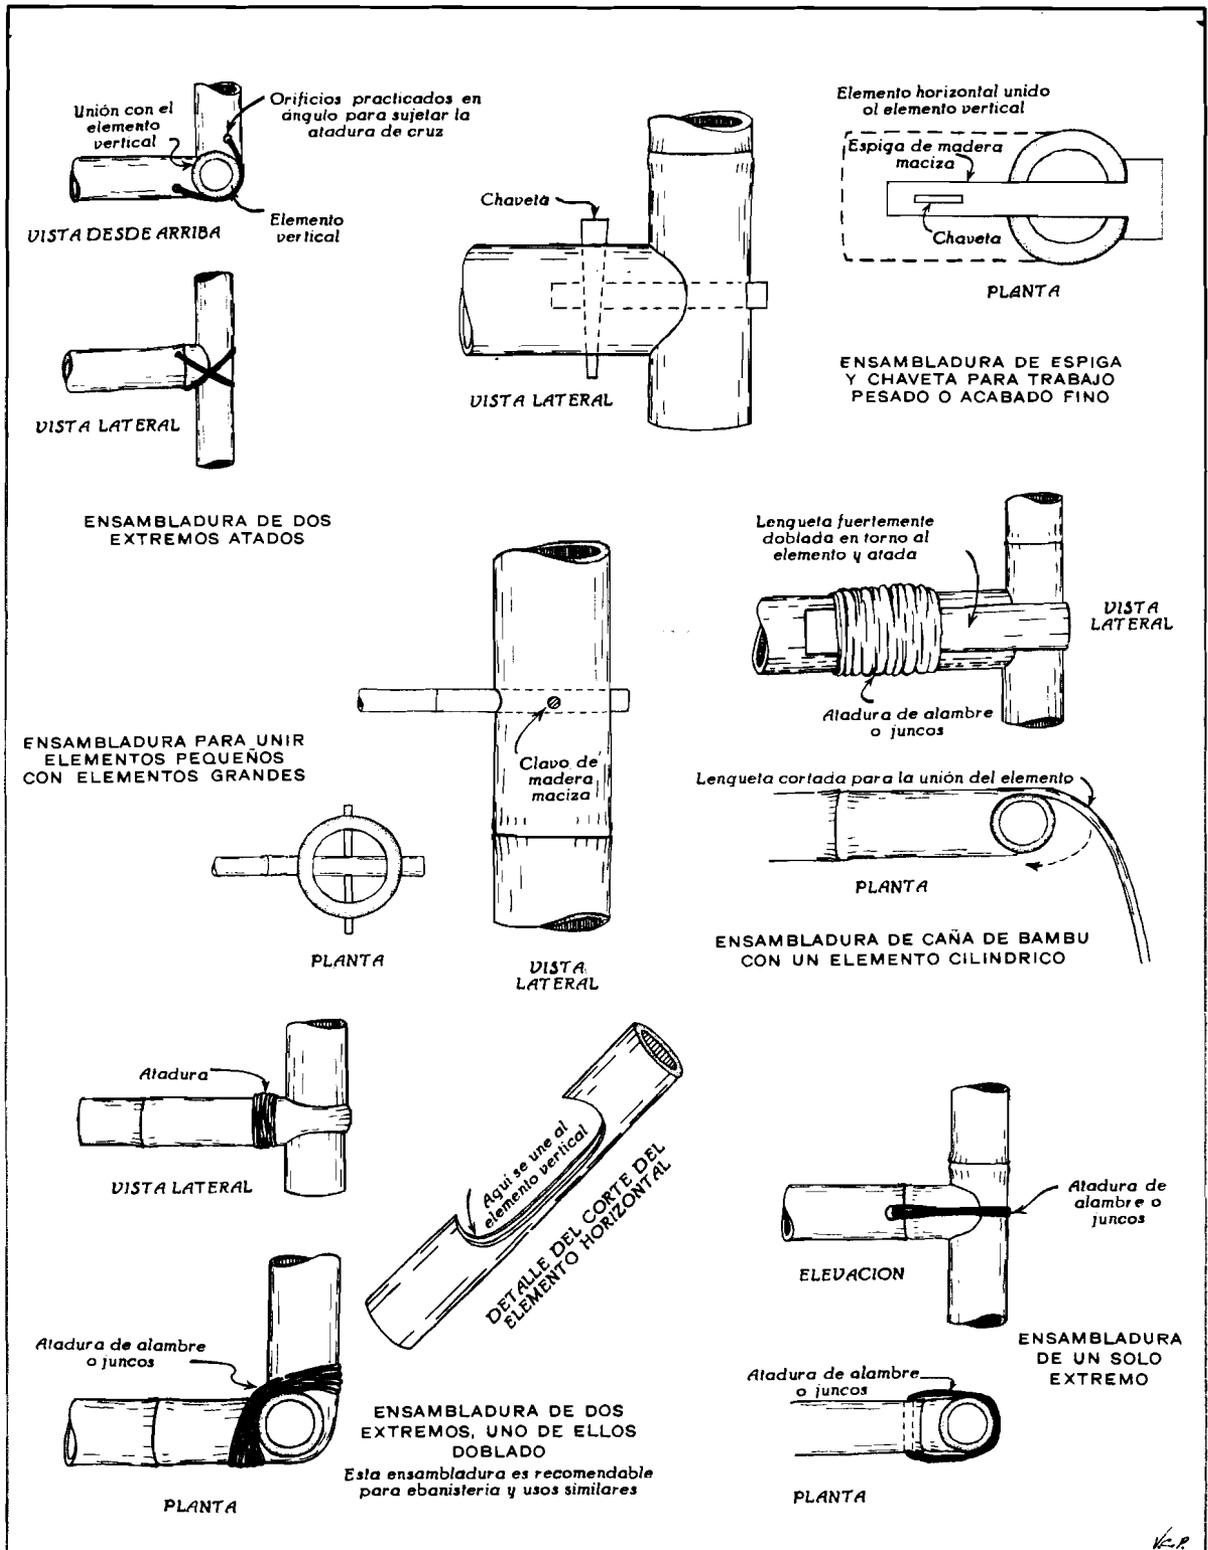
Ensambladuras empleadas en construcciones de bambú.
